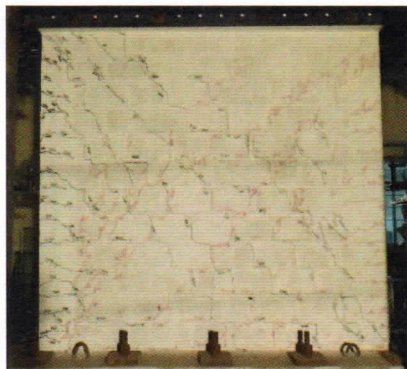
Continuación de grietas paralelo a la diagonal principal para una distorsión 1/200 Vista cara Sur.
